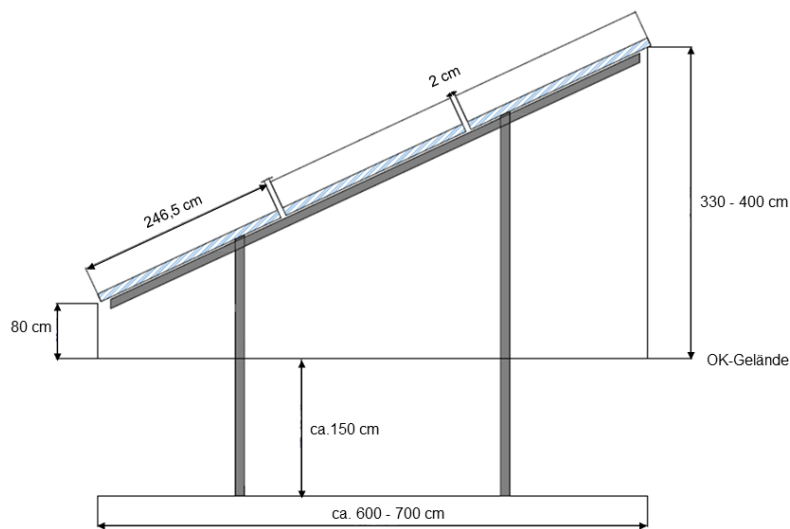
Systemschnitt Modultische, Quelle: solargrün GmbH, 2024
